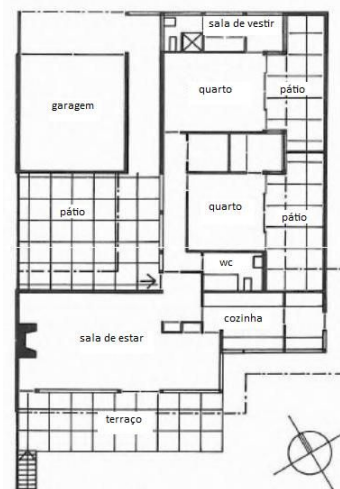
H. H. Harris Planta da Casa Lowe, em Altadena, Califórnia, 1934
